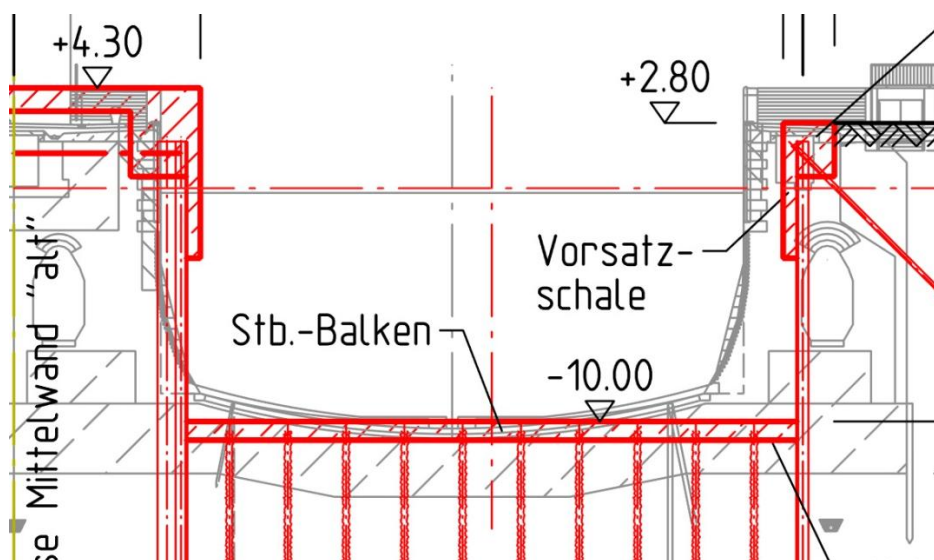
Variante 1.1a mit Sohlverstärkung durch Stahlbetonbalken
